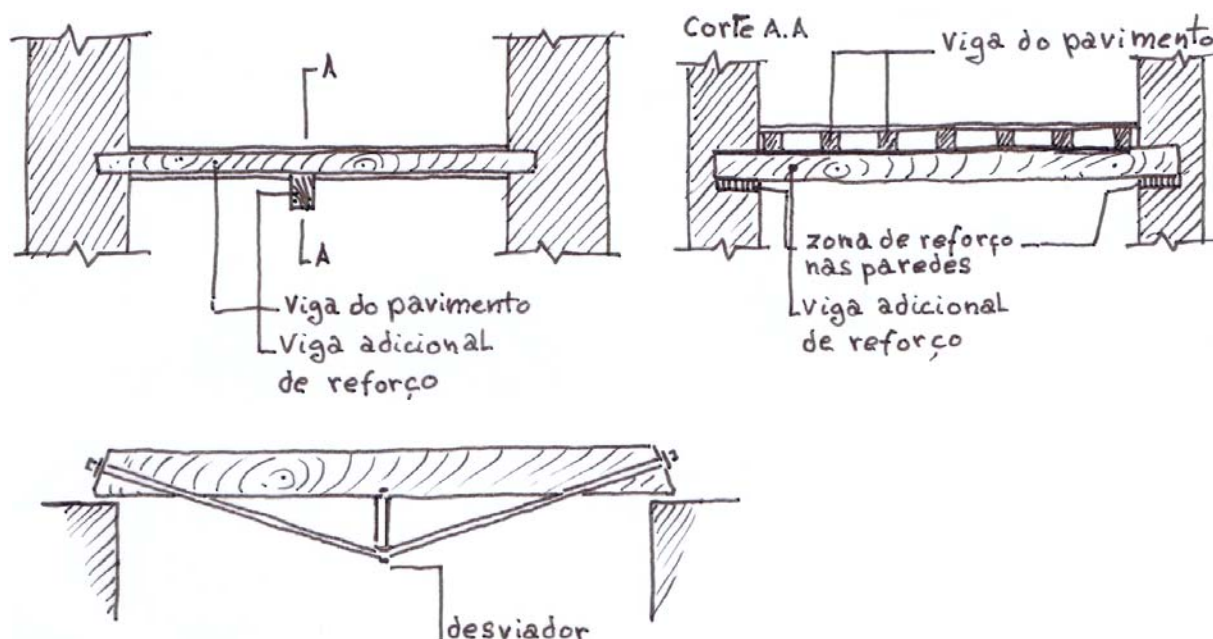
a | Colocação de viga transversal ao vigamento do pavimento
